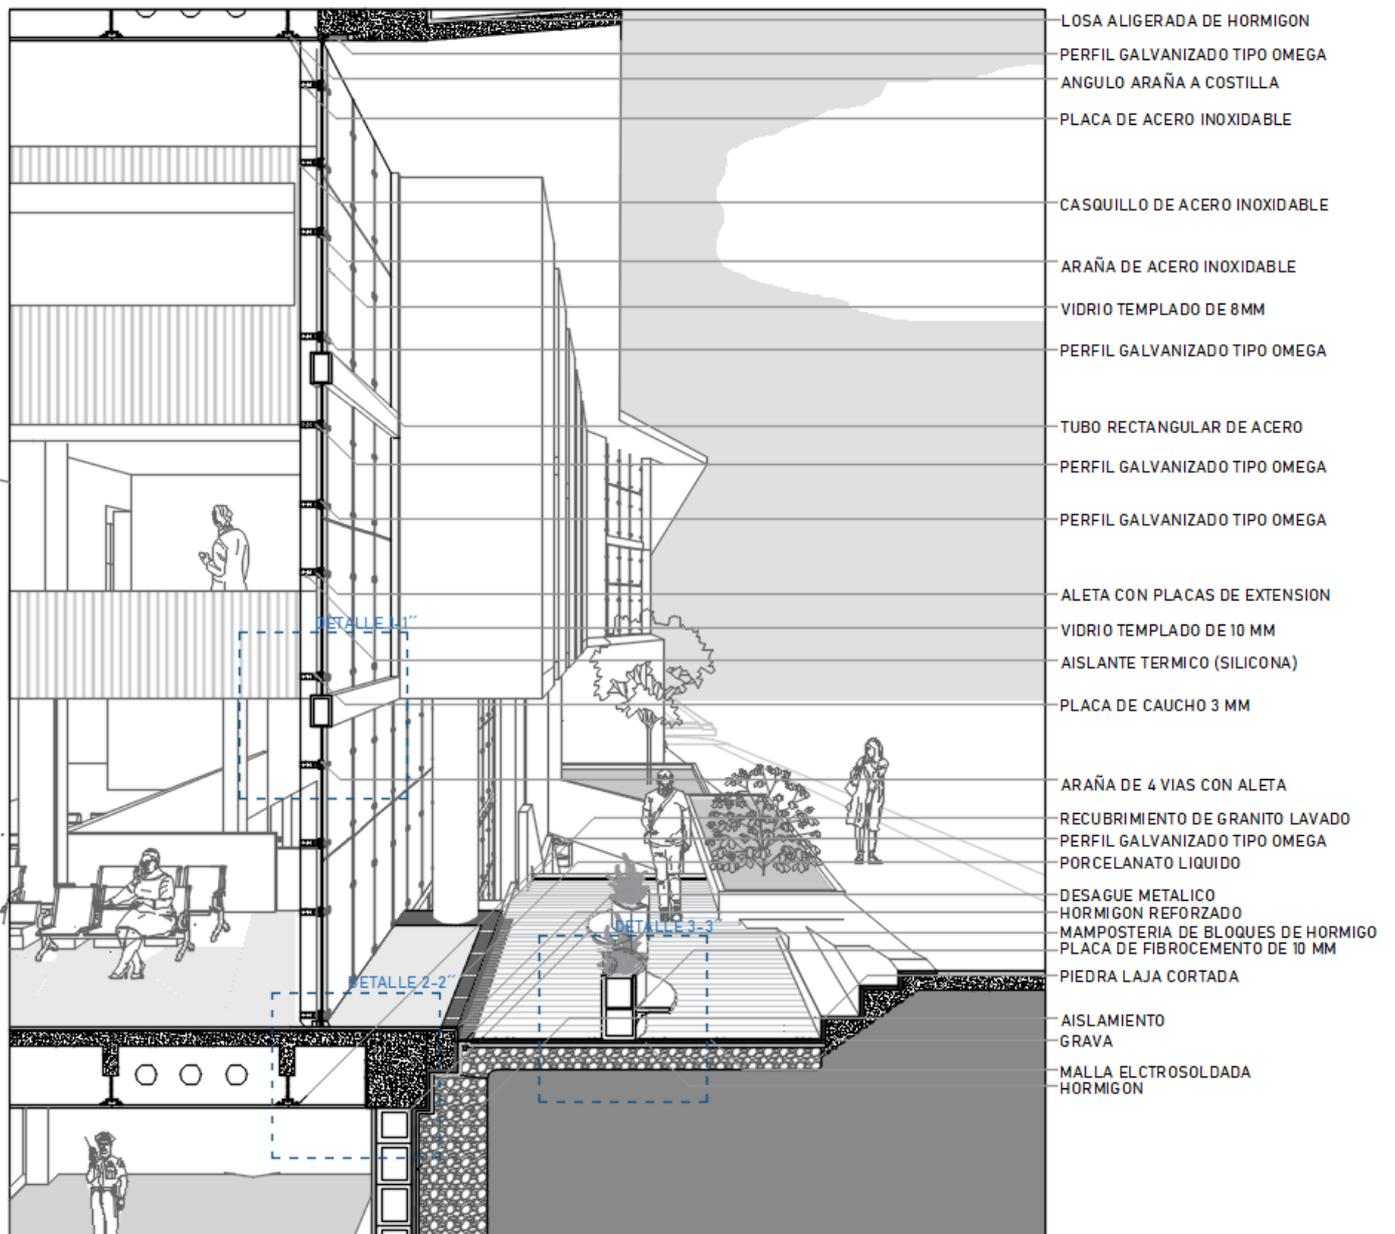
Detalle Constructivos en Fachada . Elaboracion Personal.
